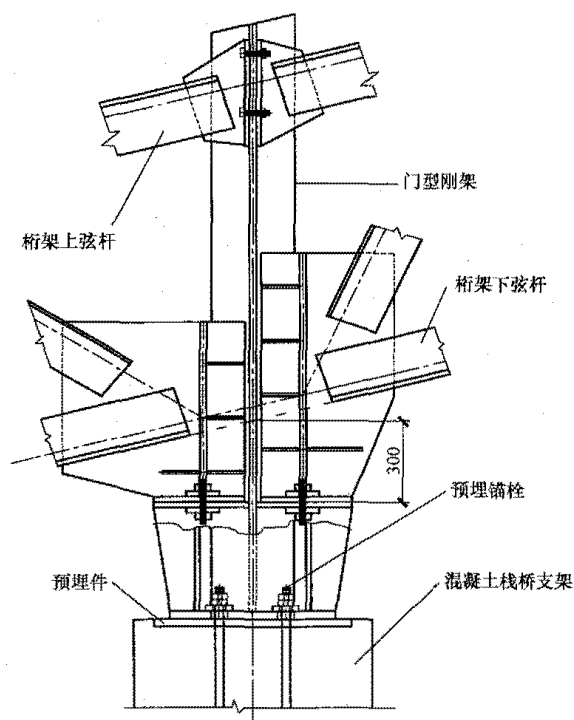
桁架支座与钢筋混凝土栈桥支架连接
